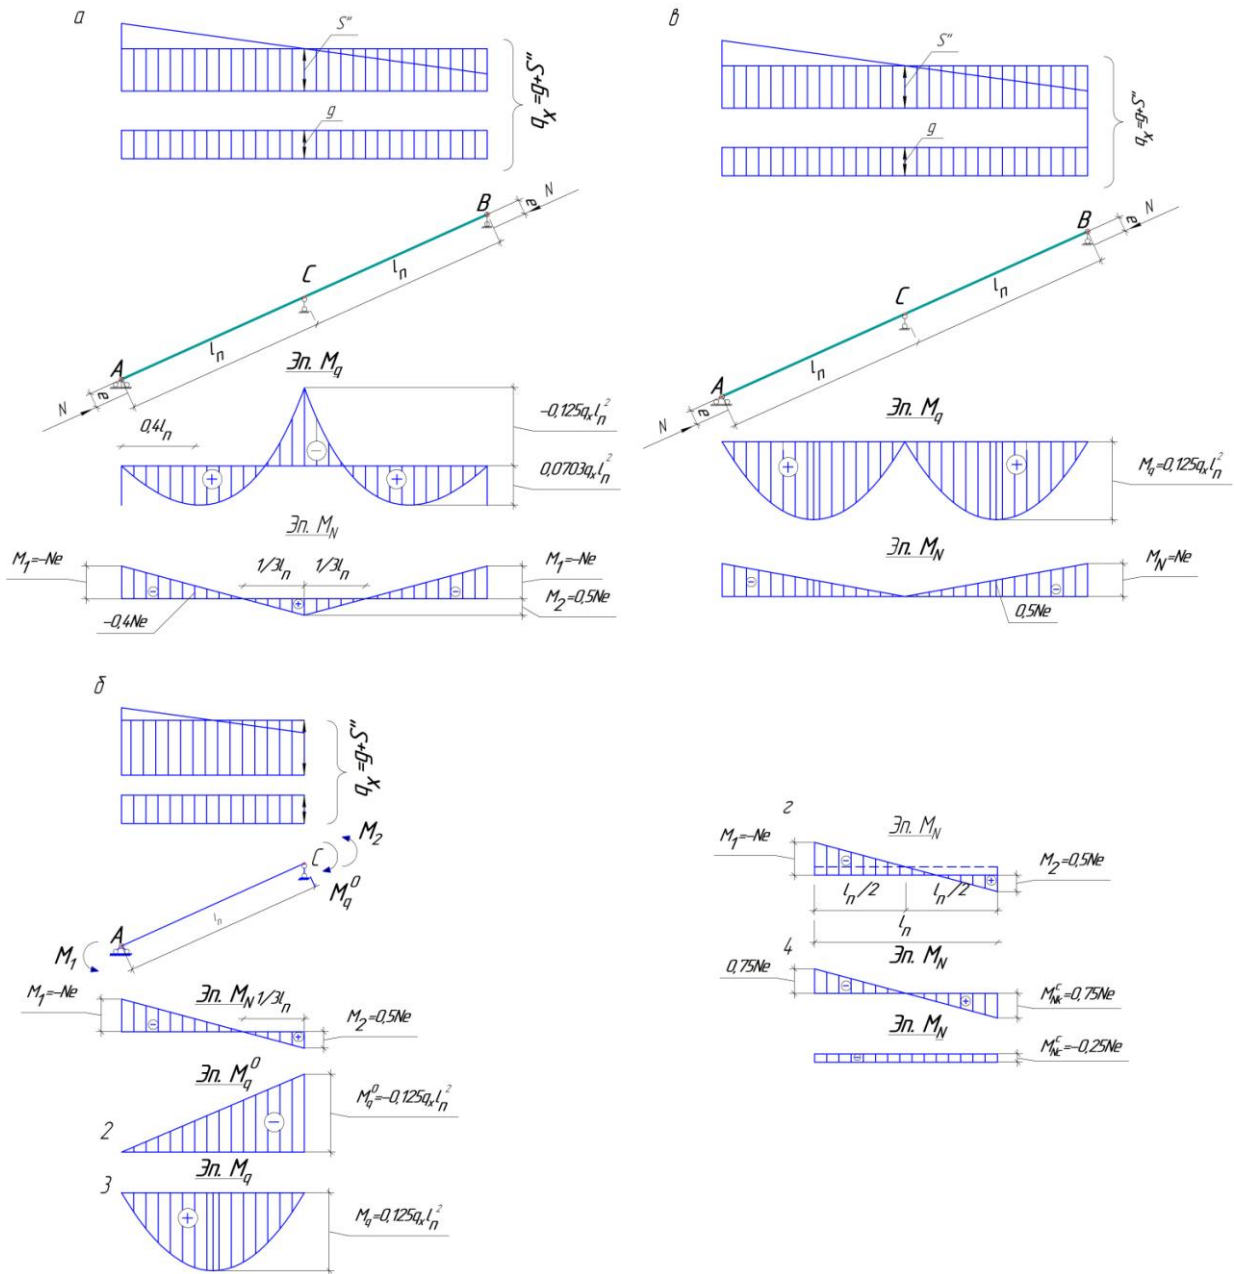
К расчету верхнего пояса многоугольной фермы
